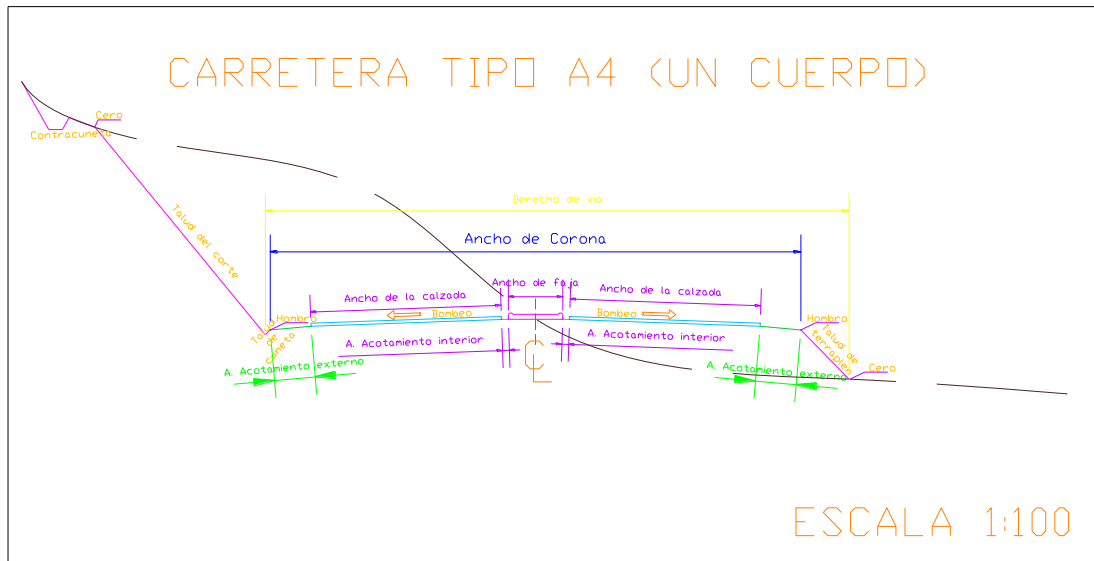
Sección de construcción de un terraplén. (Elaboración propia, 2014).
